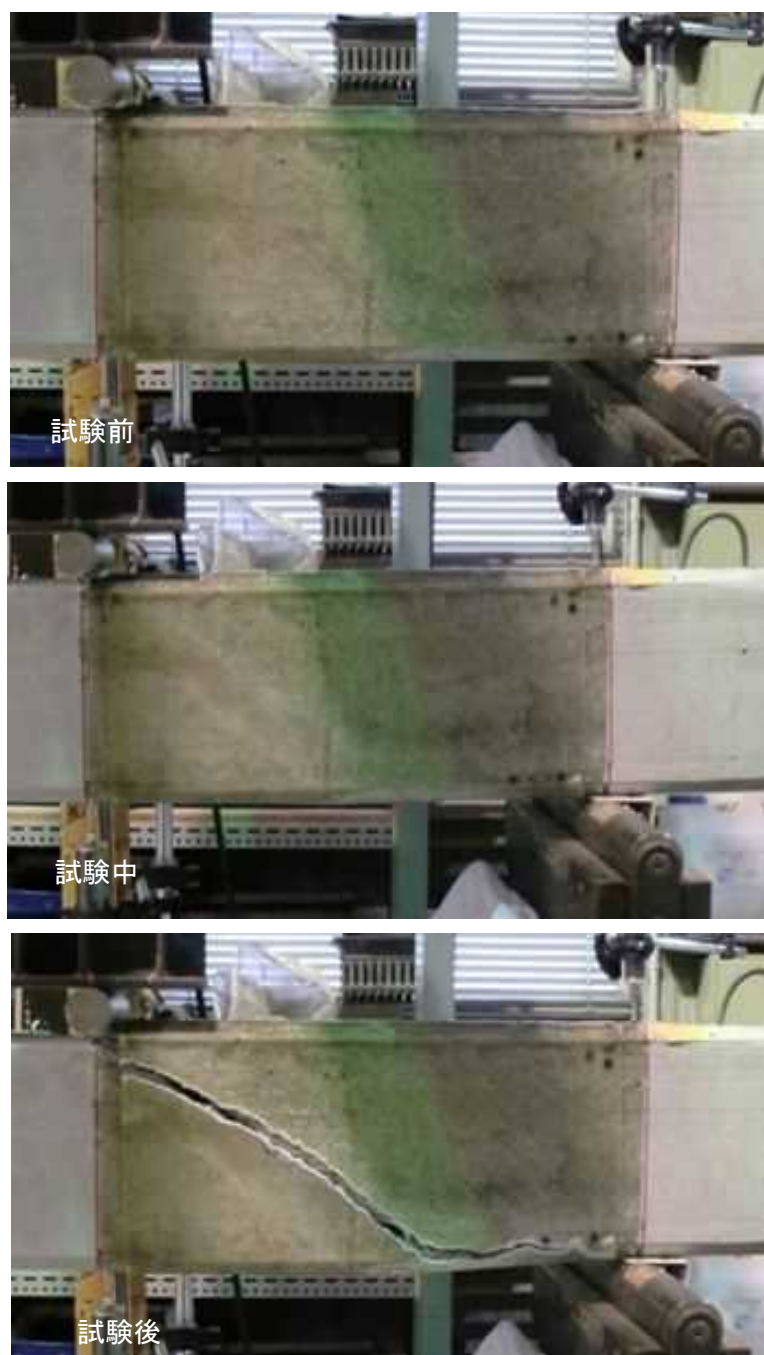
No. 3（等方性 FRP シート） せん断破壊状況
